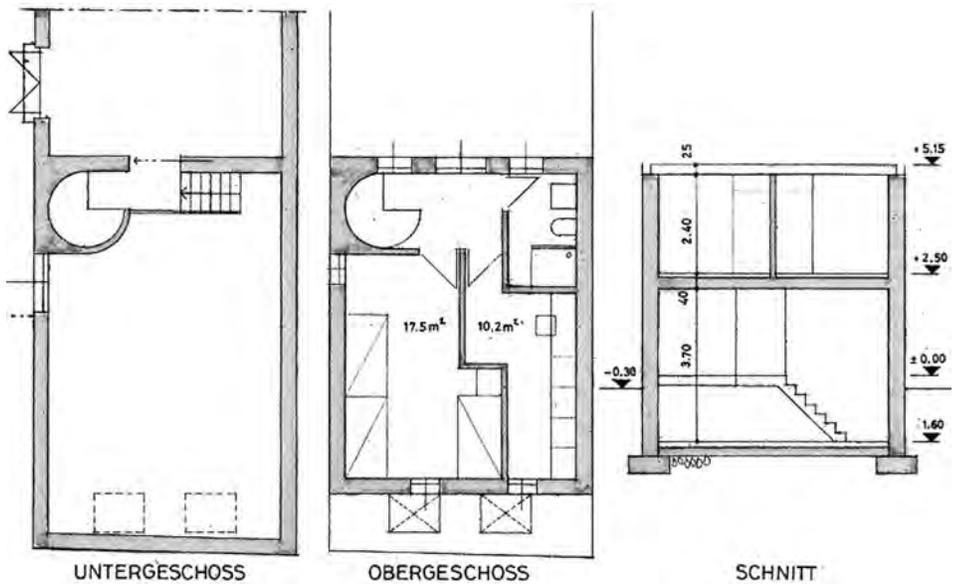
Grundriss des Corpshauses für die Renovierung 2010
